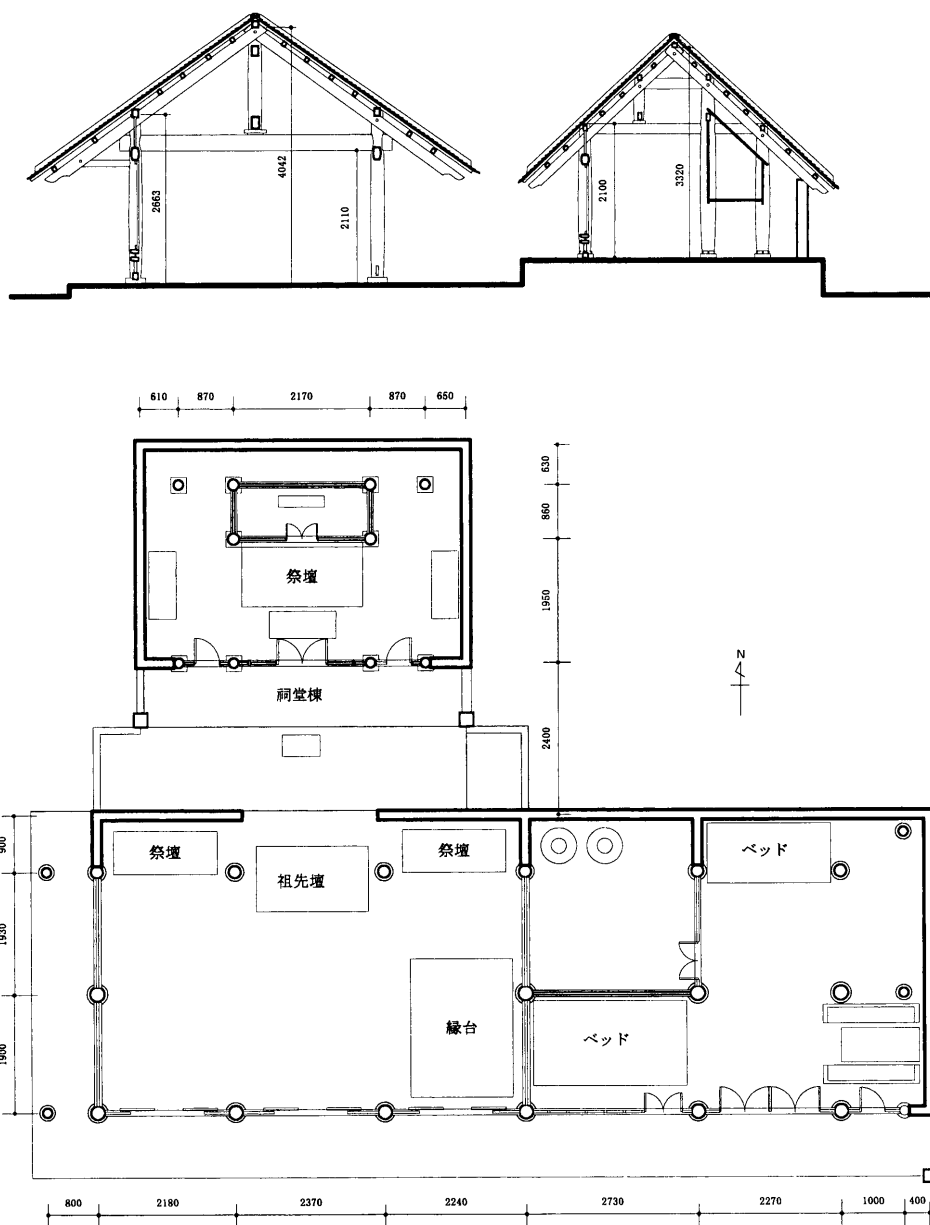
Nguyễn Cảnh Cỏ宅／断面図・平面図
